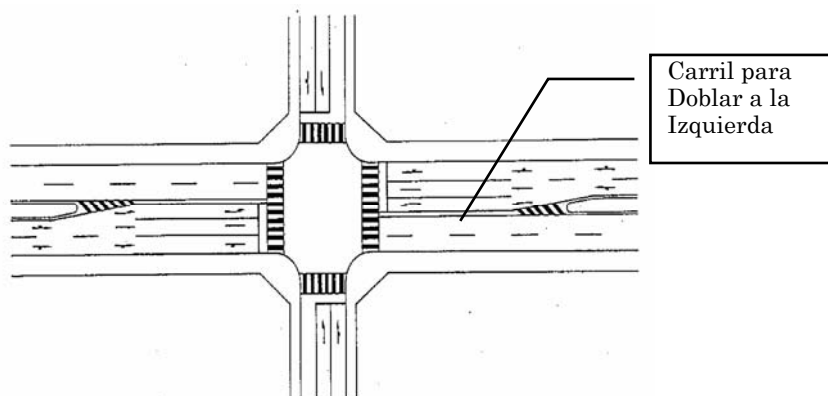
Carril Exclusivo para Doblar a la Izquierda Cortando la Línea Media
